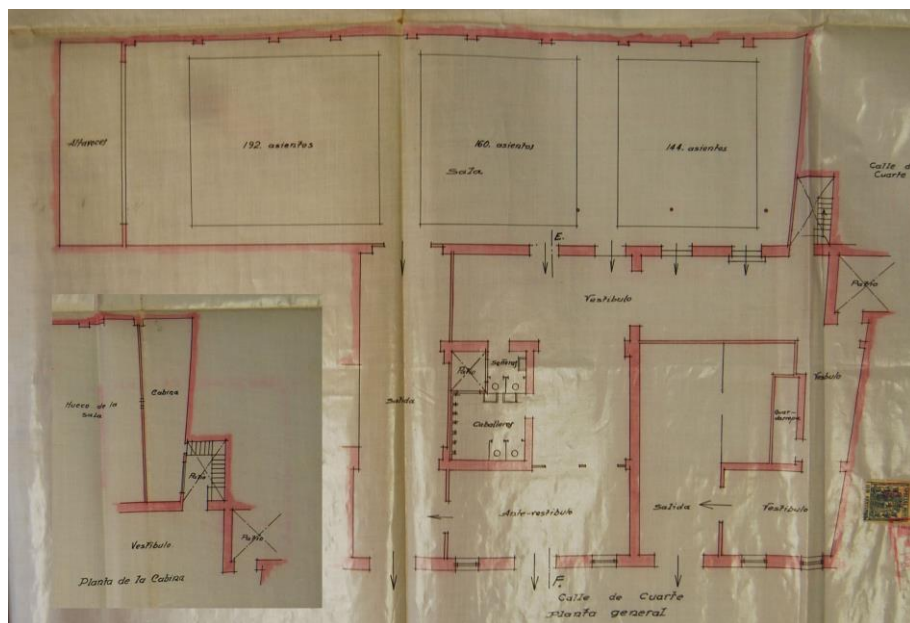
Plano de la planta baja y la planta de la cabina del Valencia Cinema
